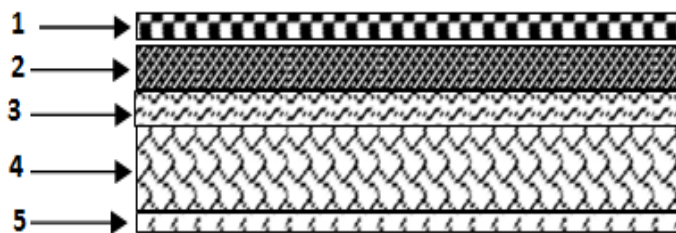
Coupe verticale d'une dalle plein(balcons)
